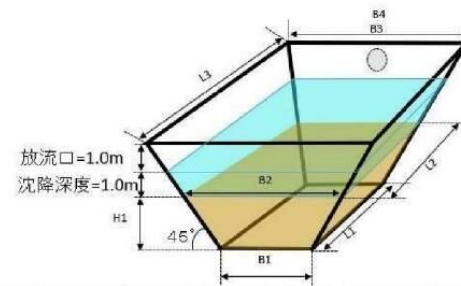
ツバクロ発生土置き場（通常土）の排水設備計画平面図
